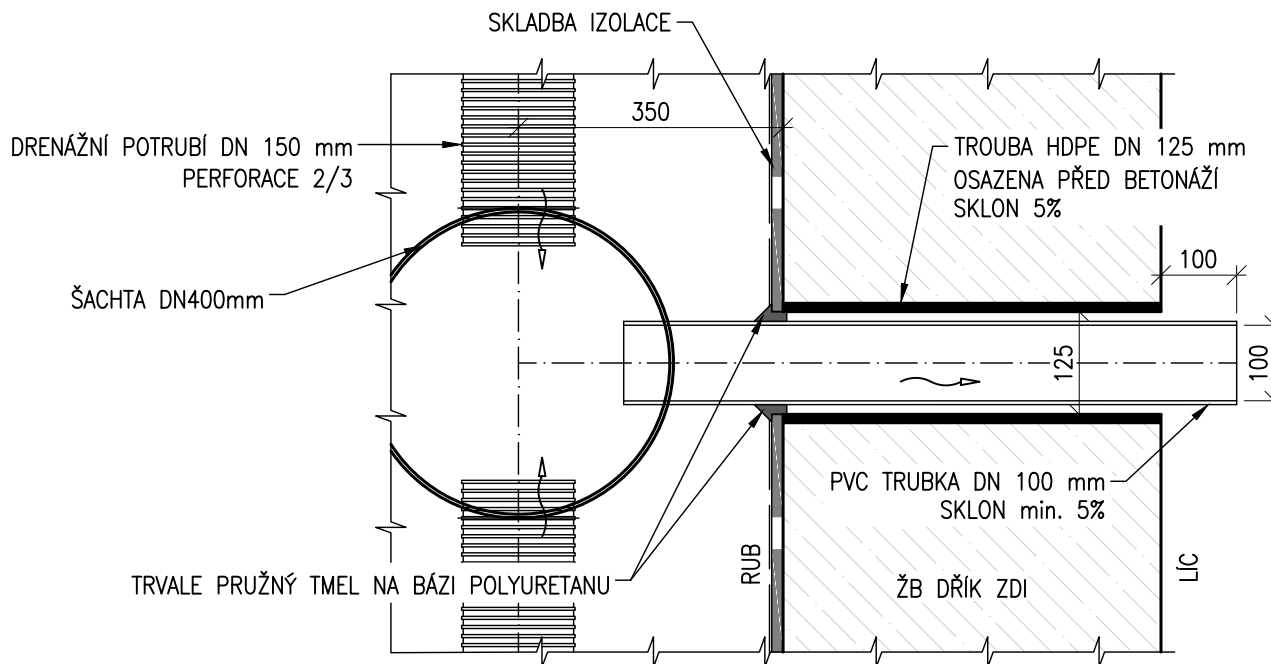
DETAIL IZOLACE NA ROZHRANÍ DŘÍKU ZÁKLADU
